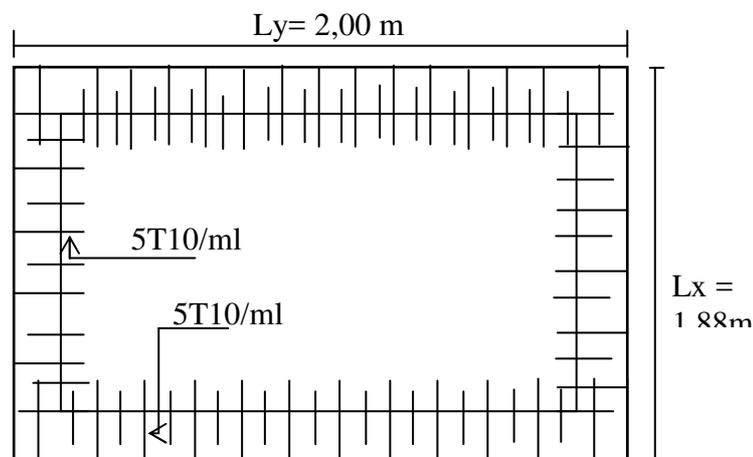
Dessin Ferrailage Supérieur du panneau de la dalle pleine.
